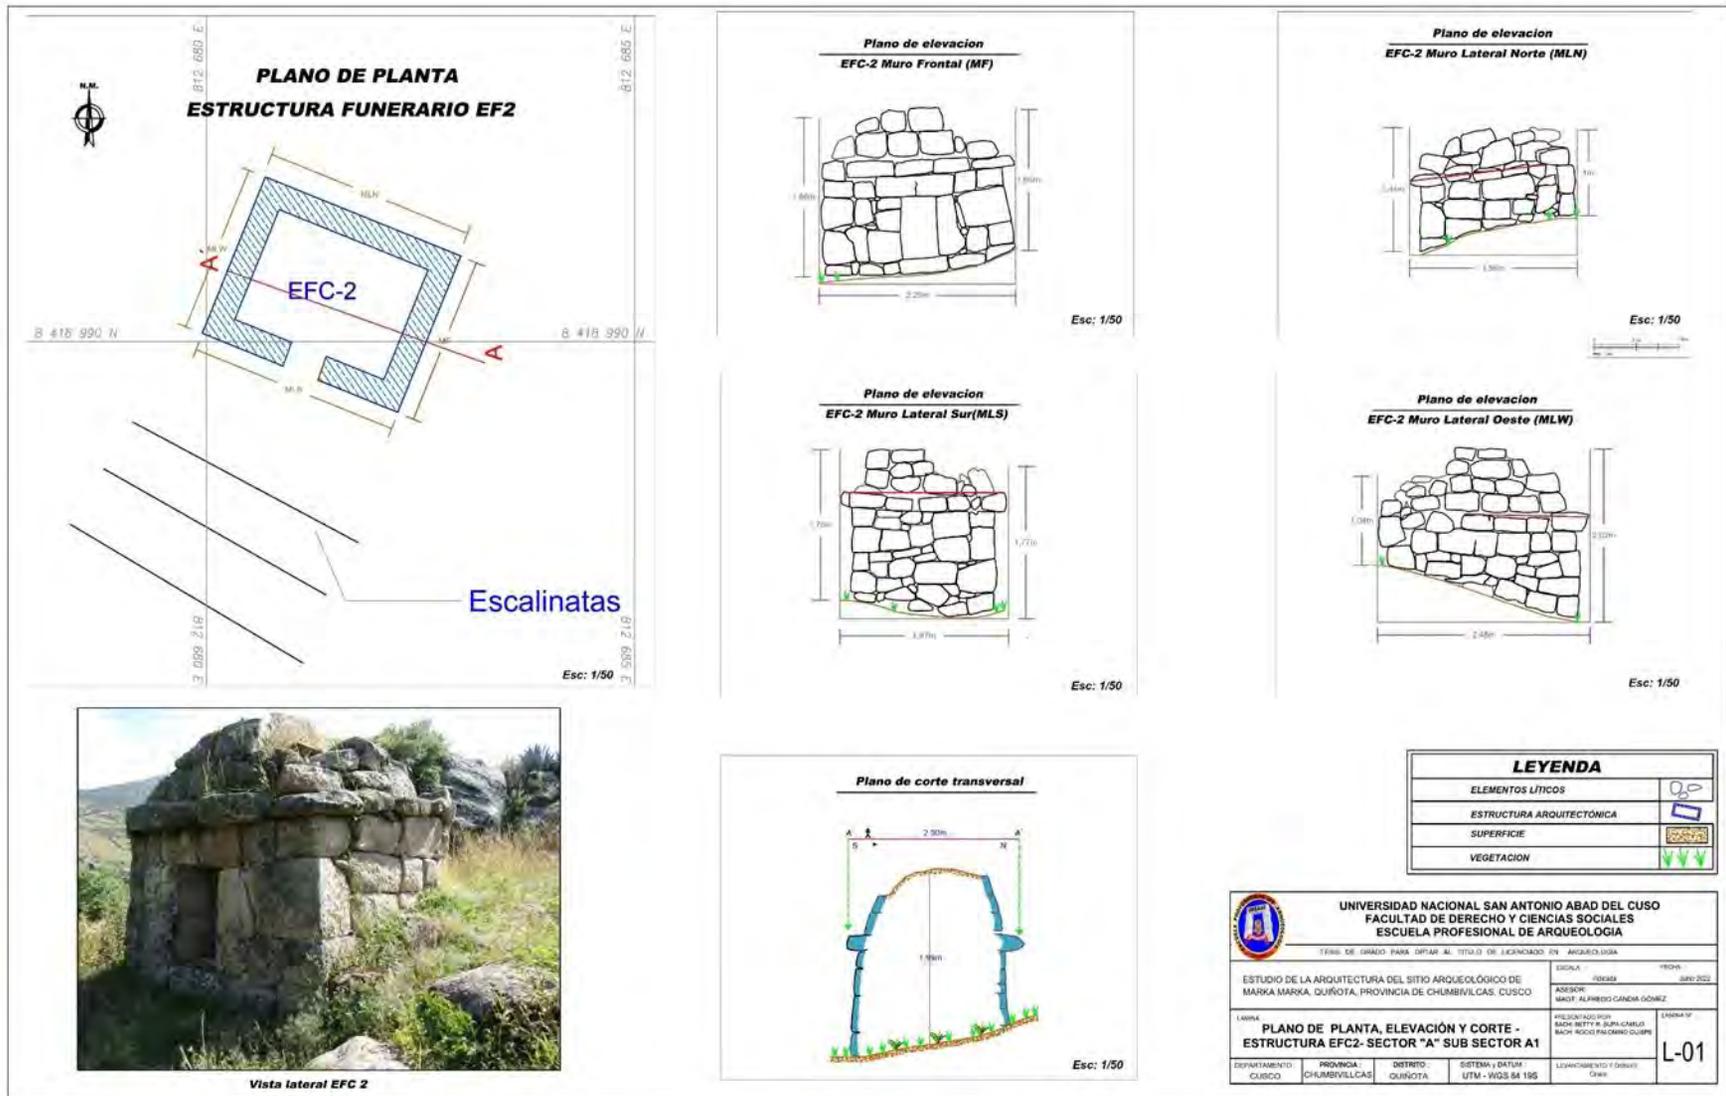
Plano de Planta Estructura Funeraria cuadrada (EFC 2)
